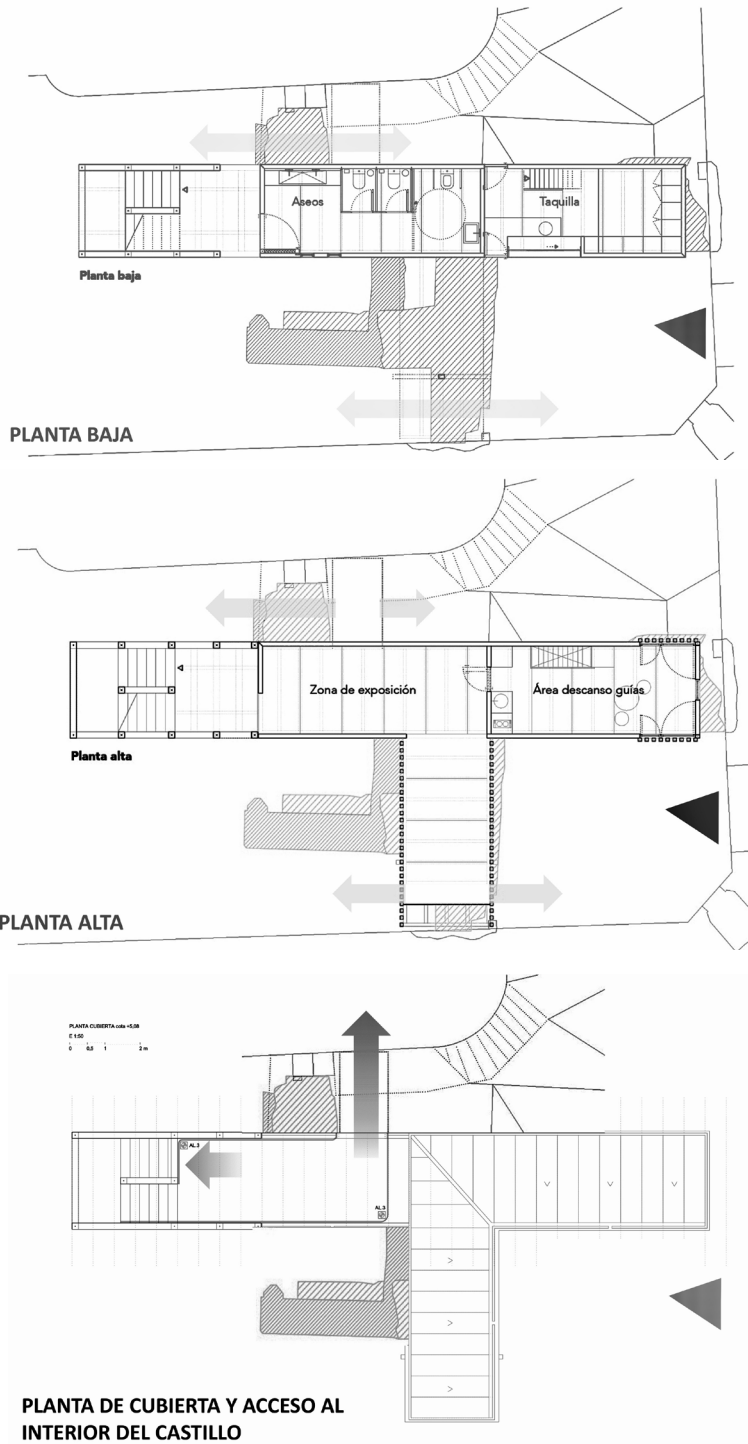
Planta baja, superior y cubierta del módulo de servicios que sirve de acceso al interior del castillo (Rocío Marina, Raúl Izquierdo y Javier Ramos).
